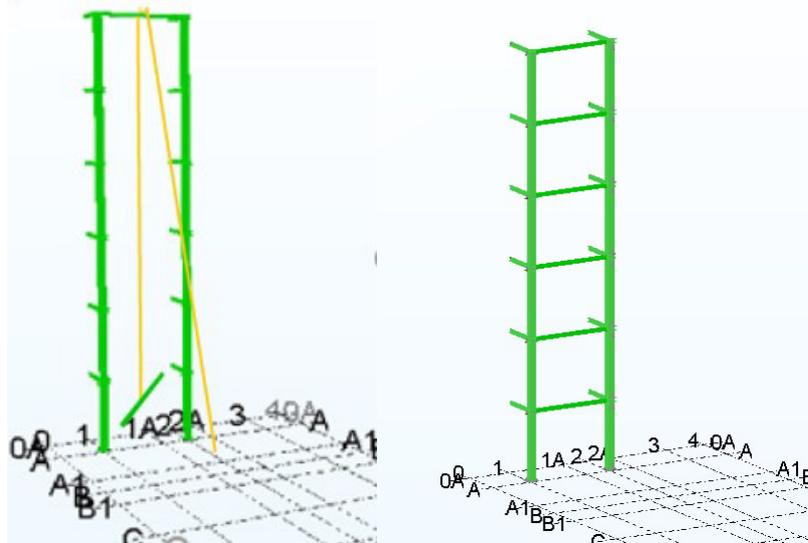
Montaje de elementos livianos con polea sujeta a la viga superior.
